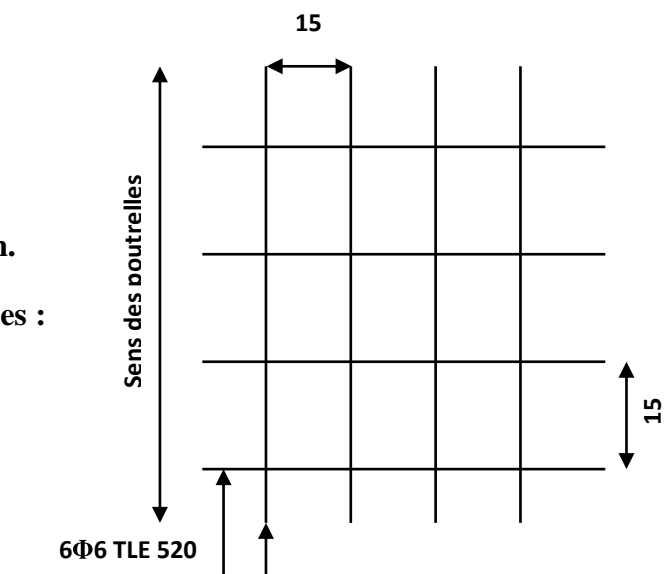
Ferrailage de la dalle de compression avec un treillis soudé
